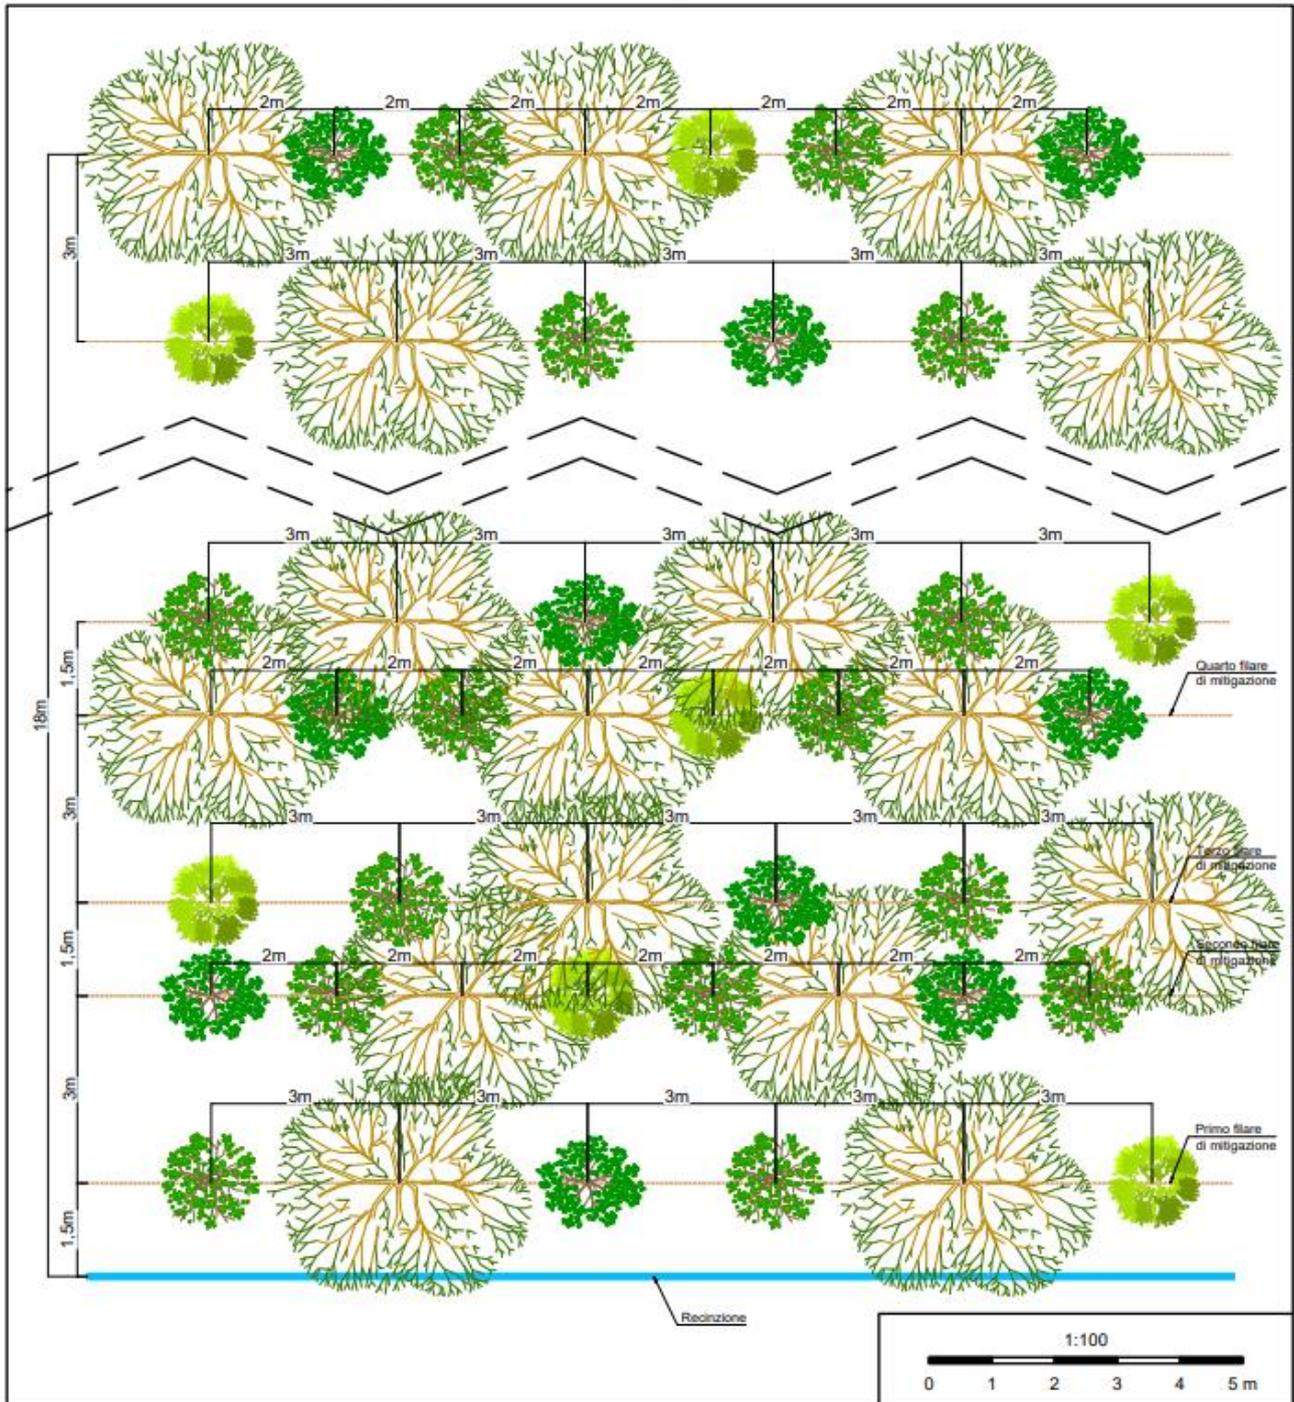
Schema di piantumazione fascia "tampone/corridoio"
